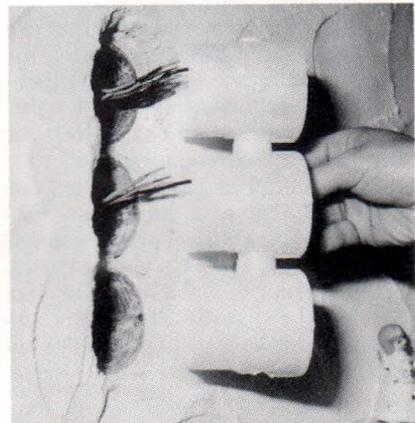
Zu tief sitzende UP-Dosen können mit dem Bauer-Aufsteckdosensystem entsprechend verlängert werden.
